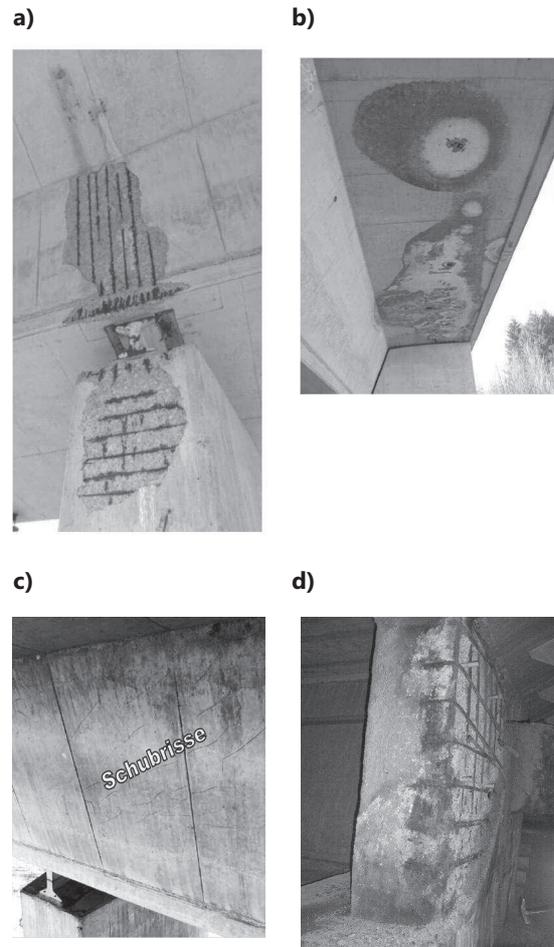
Stark geschädigten Spannbetonhohlkastenbrücke: a) Betonschäden im Bereich eines Pfeilers (Festpunkt (!)). b) Geschädigter Kragarm mit Salzausblühungen (TBW 2). c) ausgeprägte Schubrisse d) stark geschädigter Endquerträger
